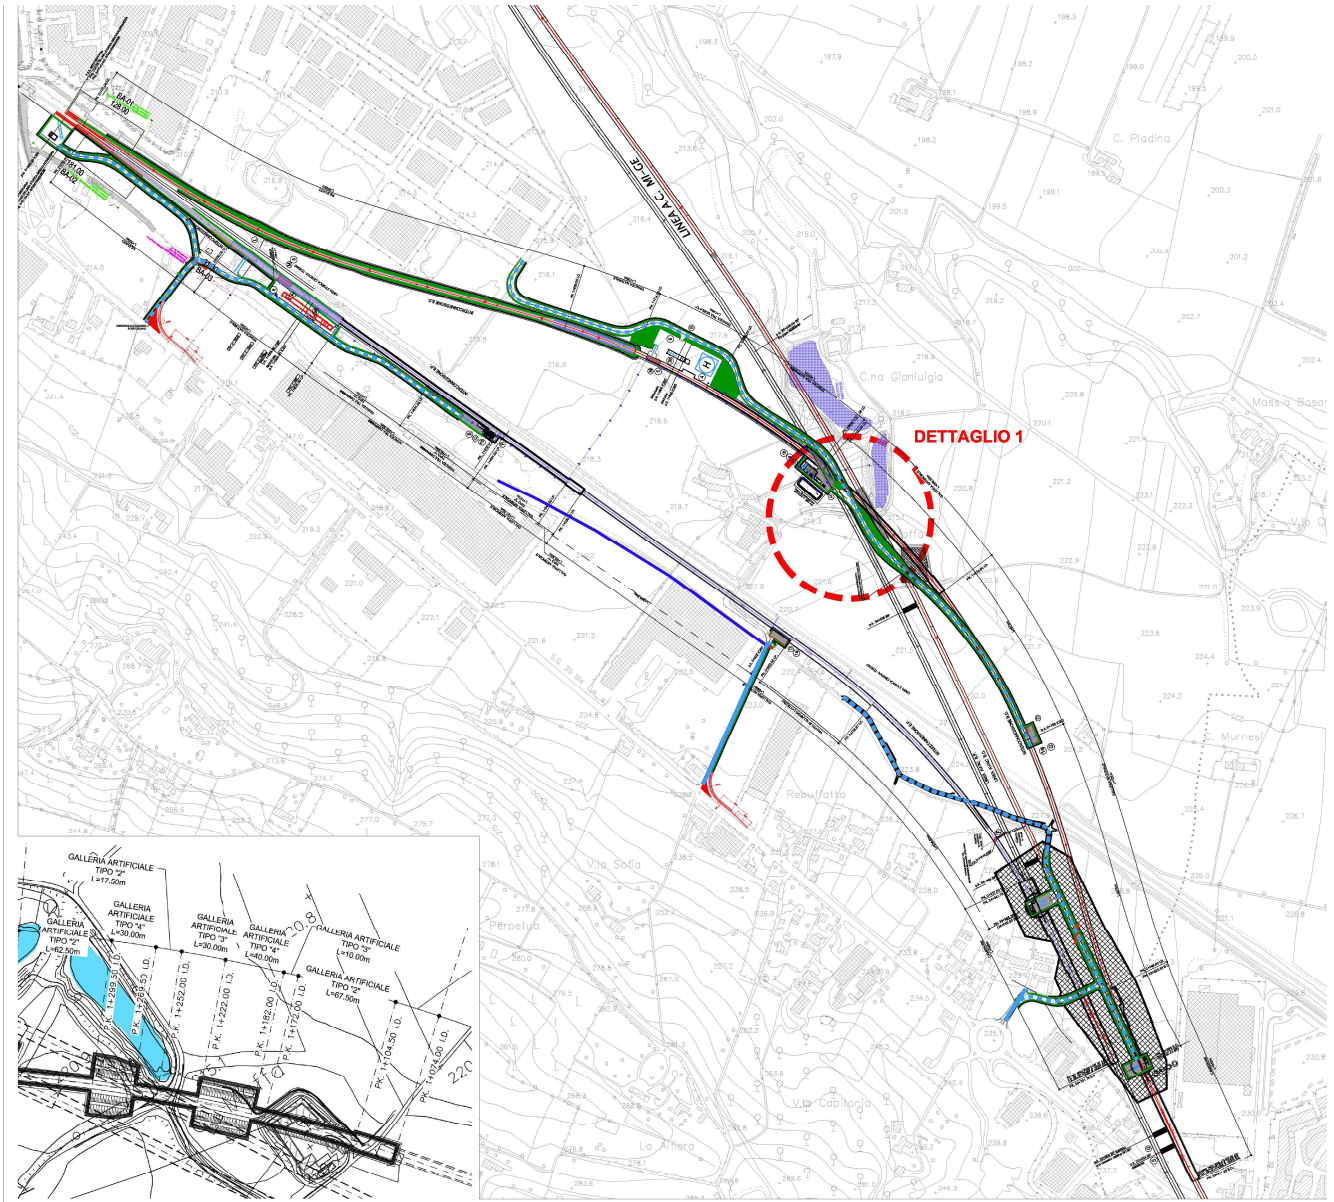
B Lo sviluppo planimetrico del progetto con l'ubicazione dell'area di cantiere, le nuove viabilità di accesso (e dettaglio sul tratto di trincea drenante)
